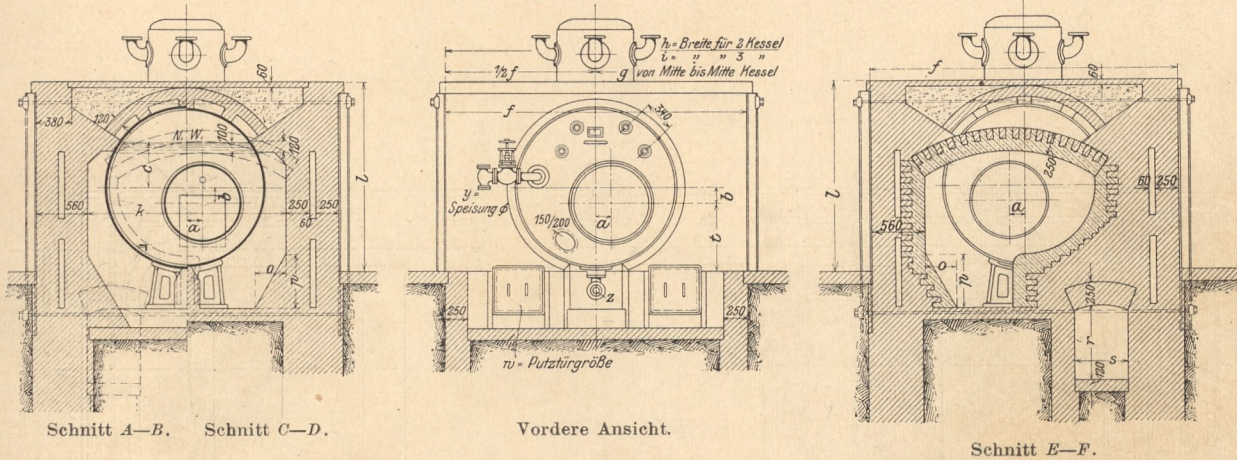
Einmauerung für normale Einflammrohr-Wellrohrkessel von 1100—2200 mm Manteldurchmesser.
